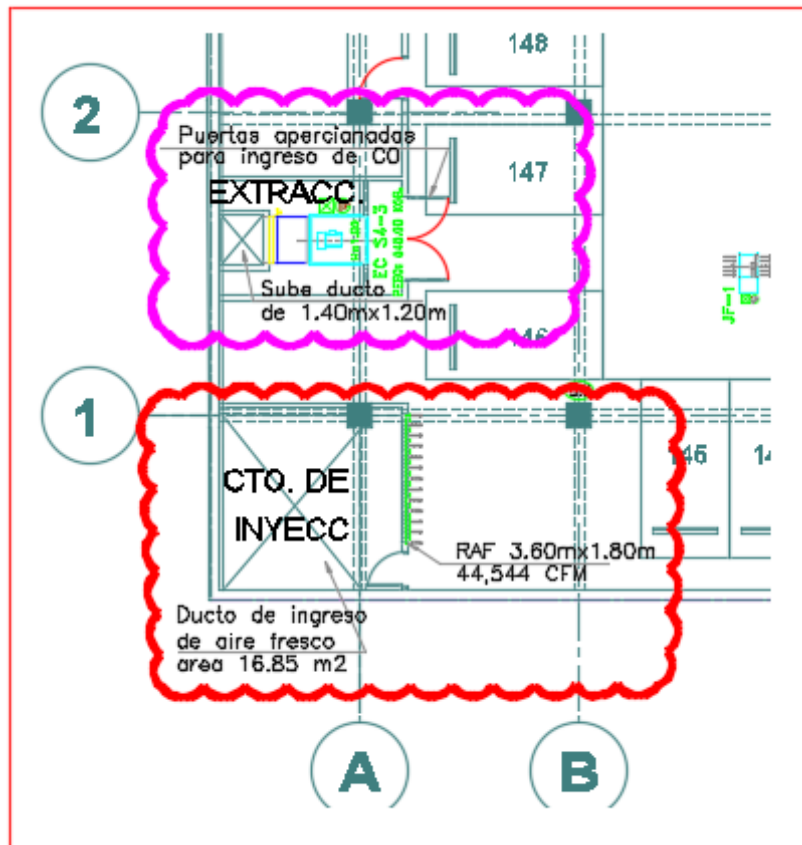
PLANTA PARCIAL 4º SÓTANO – EJES 1,2-A Y 1,2-B
